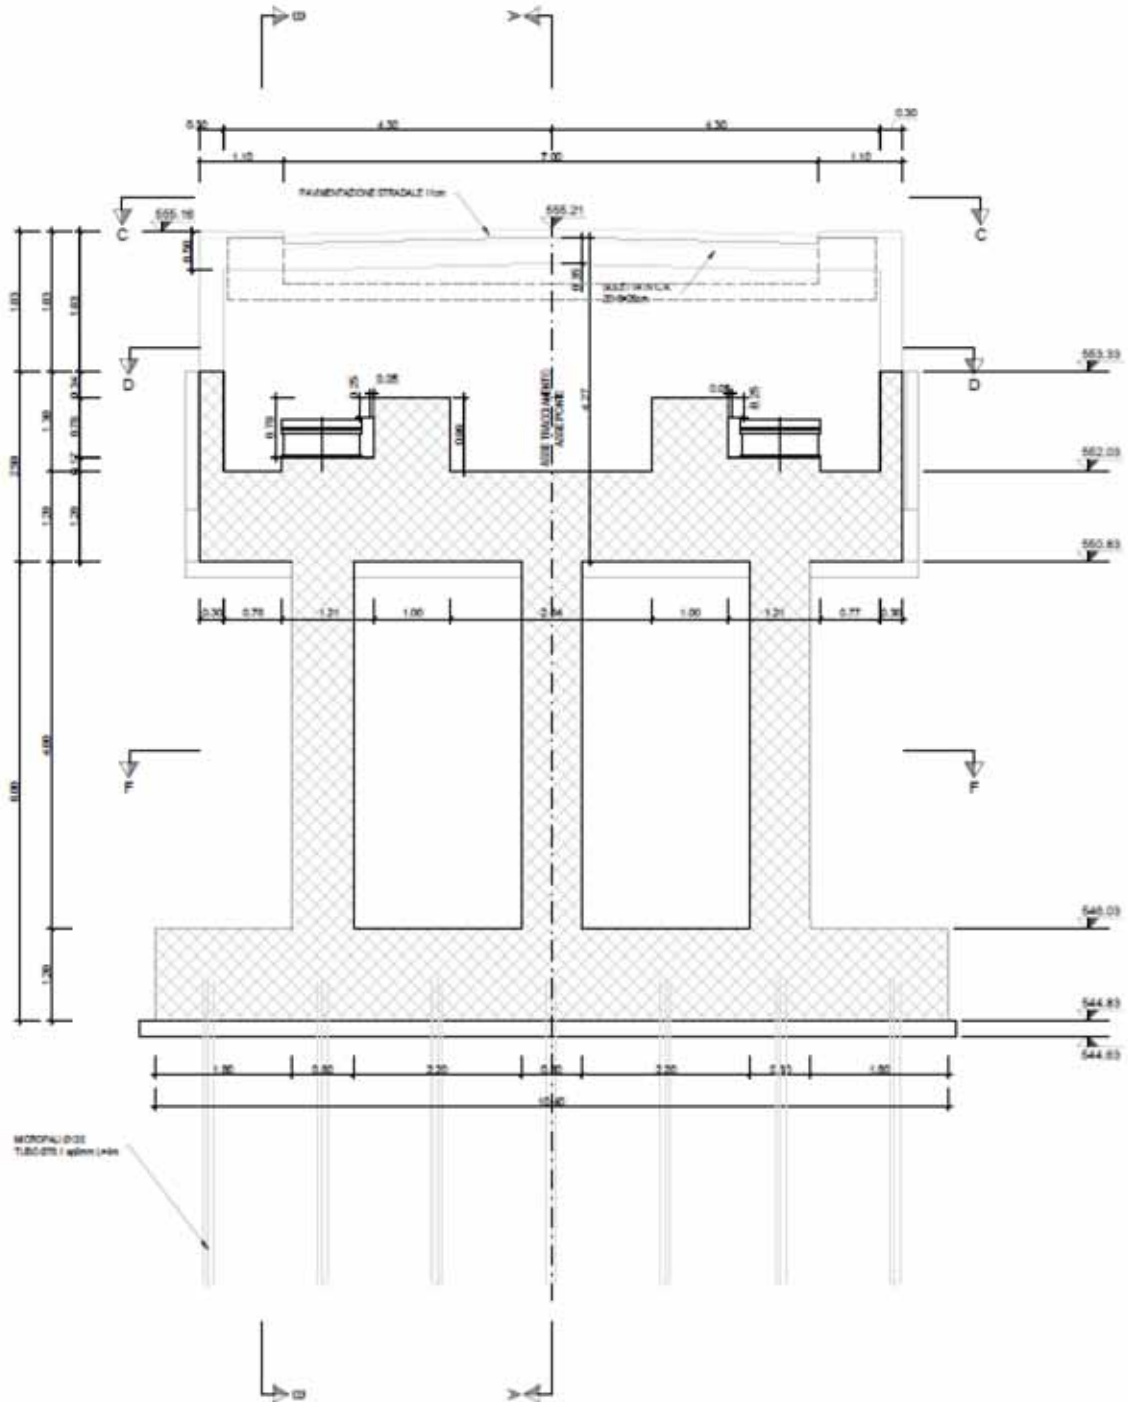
SPALLA B – Sezione longitudinale
